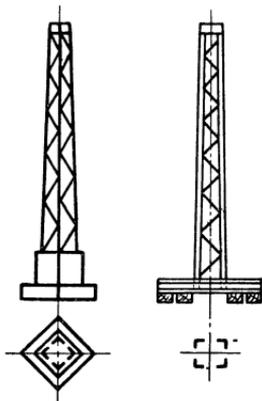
Eisenmast mit Betonfundament. Plattenfundament.
